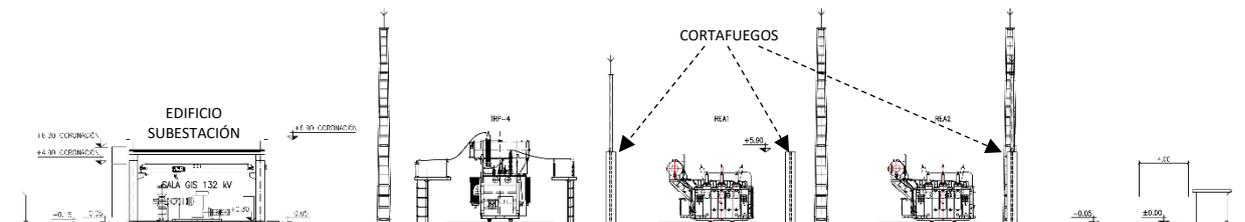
Vista de perfil de la sección central de la parcela, con la nueva subestación prevista
